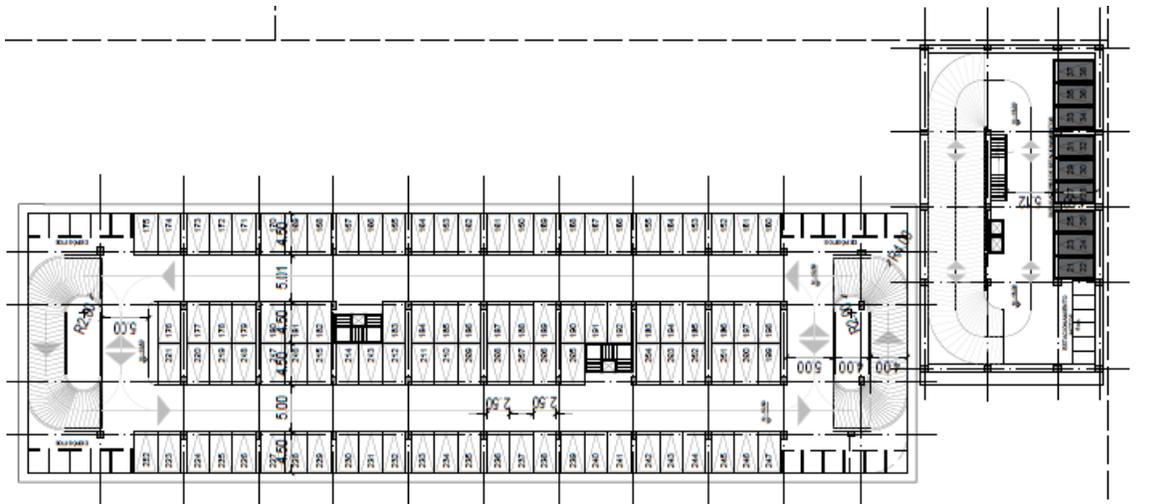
PF13. Planta Estacionamientos – Sótano 3
